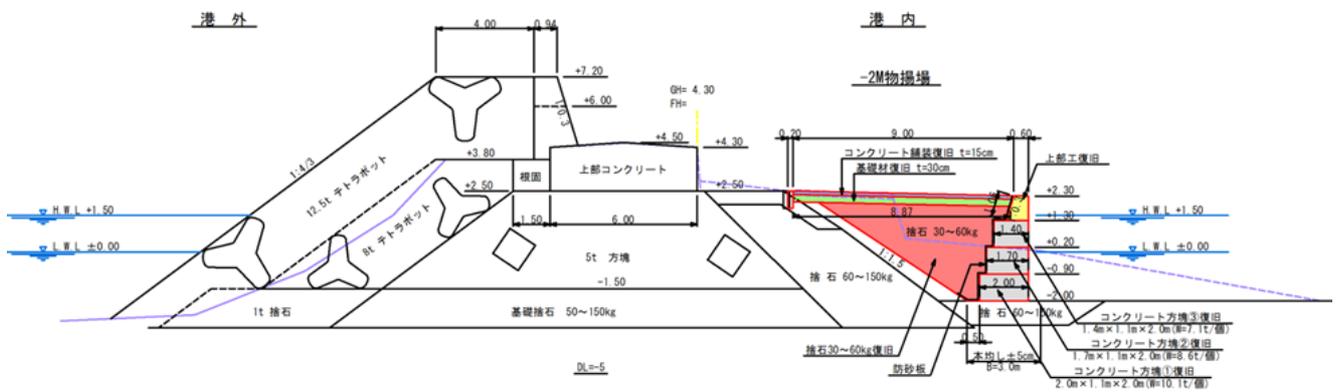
264 No.25 大洗港区_第1埠頭地区 B 物揚場 (-2m) の断面図 (復旧後)
